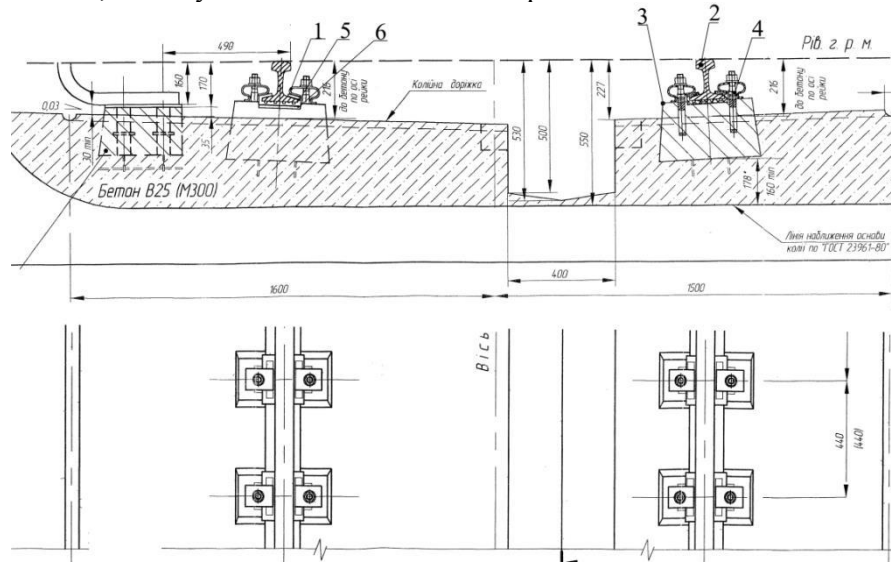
Конструкція скріплення КДП-1 на опорах БПО: 1 – клема пружна пластинчата; 2 – рейка; 3 – опора БПО; 4 – металева реборда; 5 – підрейкова гумова підкладка; 6 – додаткова ізолююча регулююча прокладка
